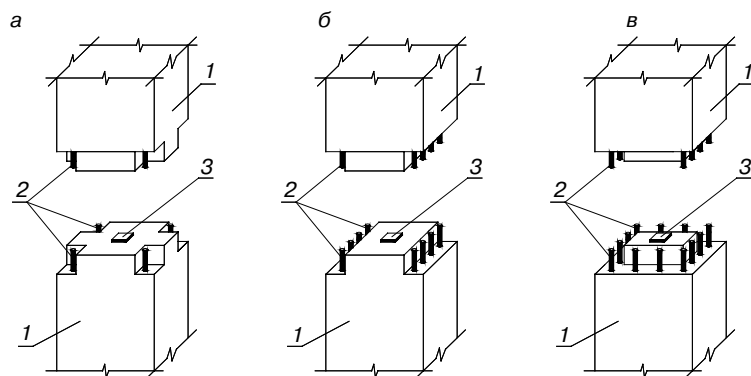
Примеры плоских стыков сборных колонн с применением сварных соединений выпусков: а – с угловой подрезкой; б – с боковой подрезкой; в – с подрезкой по периметру; 1 – сборная колонна; 2 – выпуски рабочей арматуры колонны; 3 – стальная прокладка
